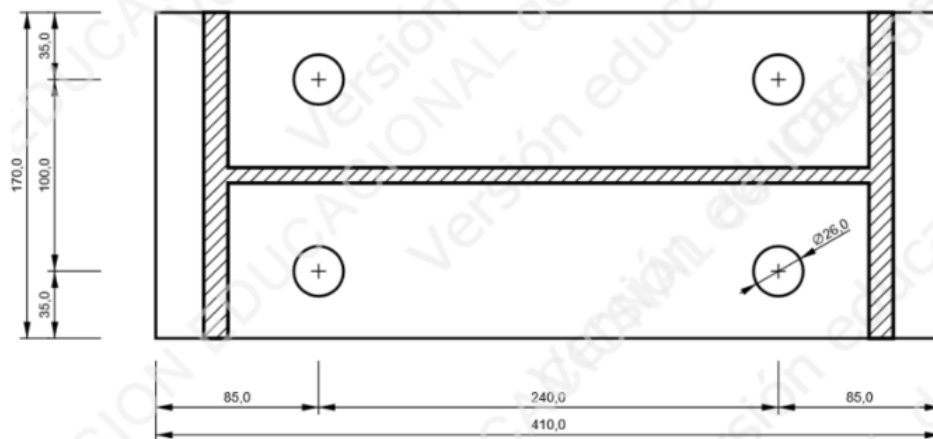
Placa de testa de la unión de IPE360 sin cartela
